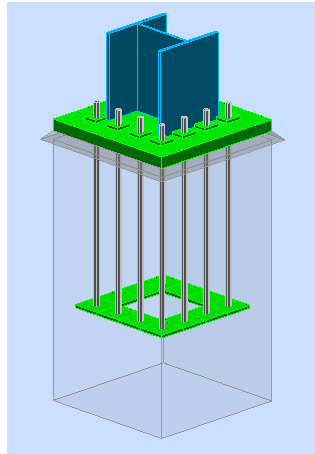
Pormenor da Ligação Coluna – Plinto.
